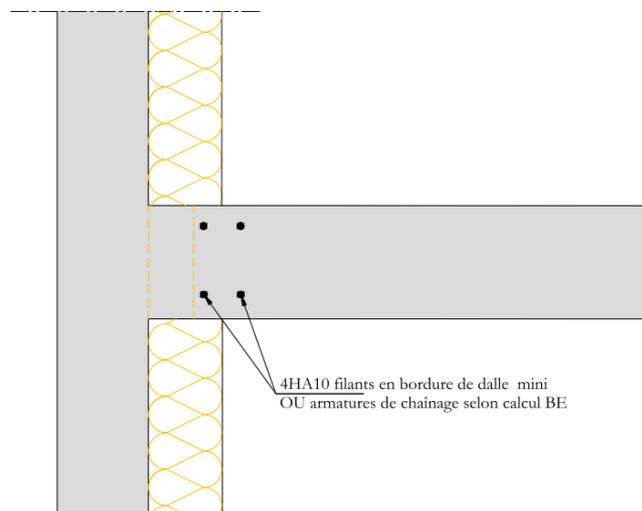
Détail de la bride – Cas des dalles coulées sur place avec balcon
